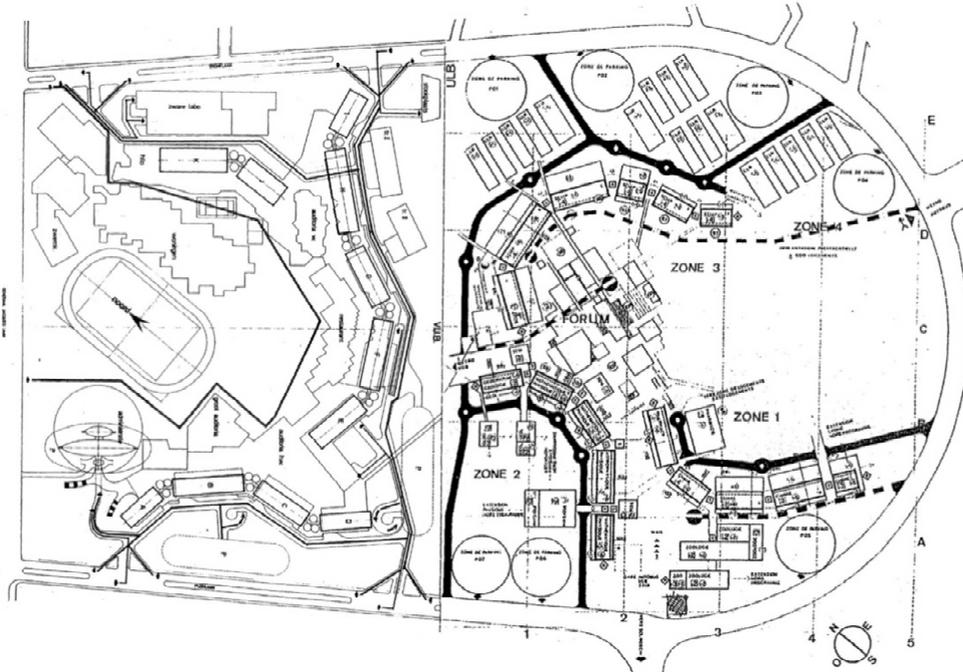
Plan masse d'ensemble - superposition du plan masse de la VUB et de l'ULB. (Sources: Plan "Le Maresquier" VUB, Département des Infrastructures Projets et Constructions ULB).
